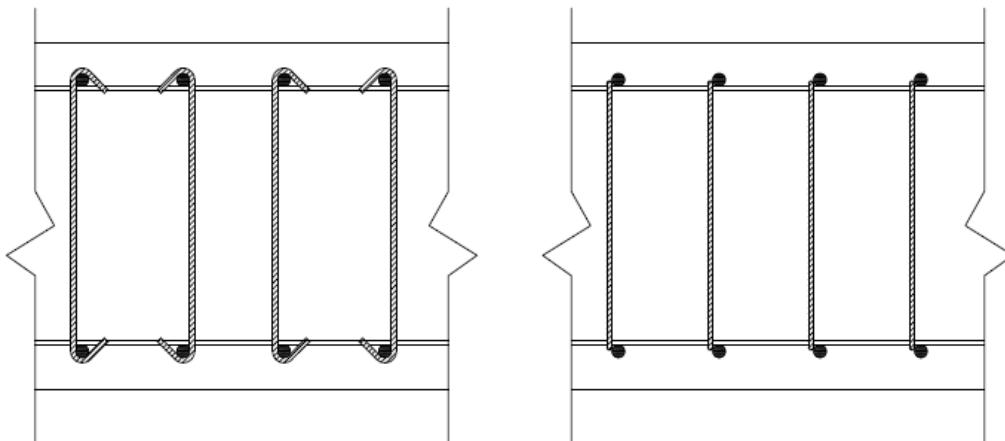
Exemplos de colocação de armadura de esforço transversal
